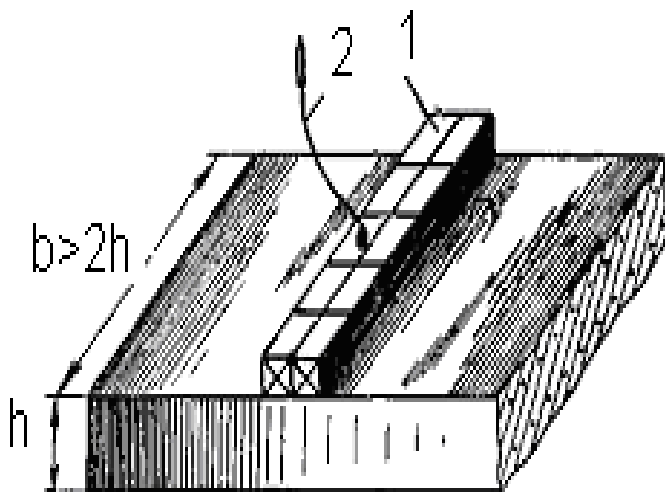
Взрывание железобетонной плиты наружным удлиненным зарядом:
